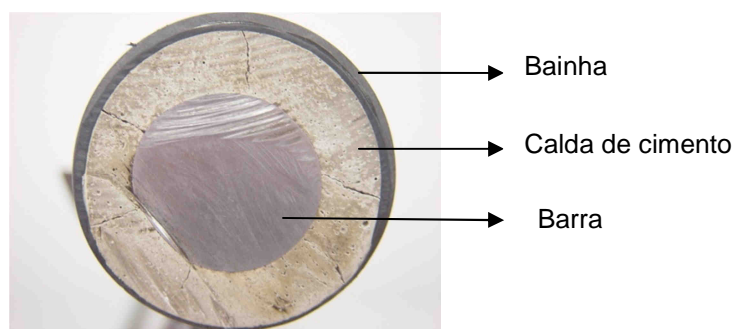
Secção transversal da armadura de pré-esforço exterior em barra.
